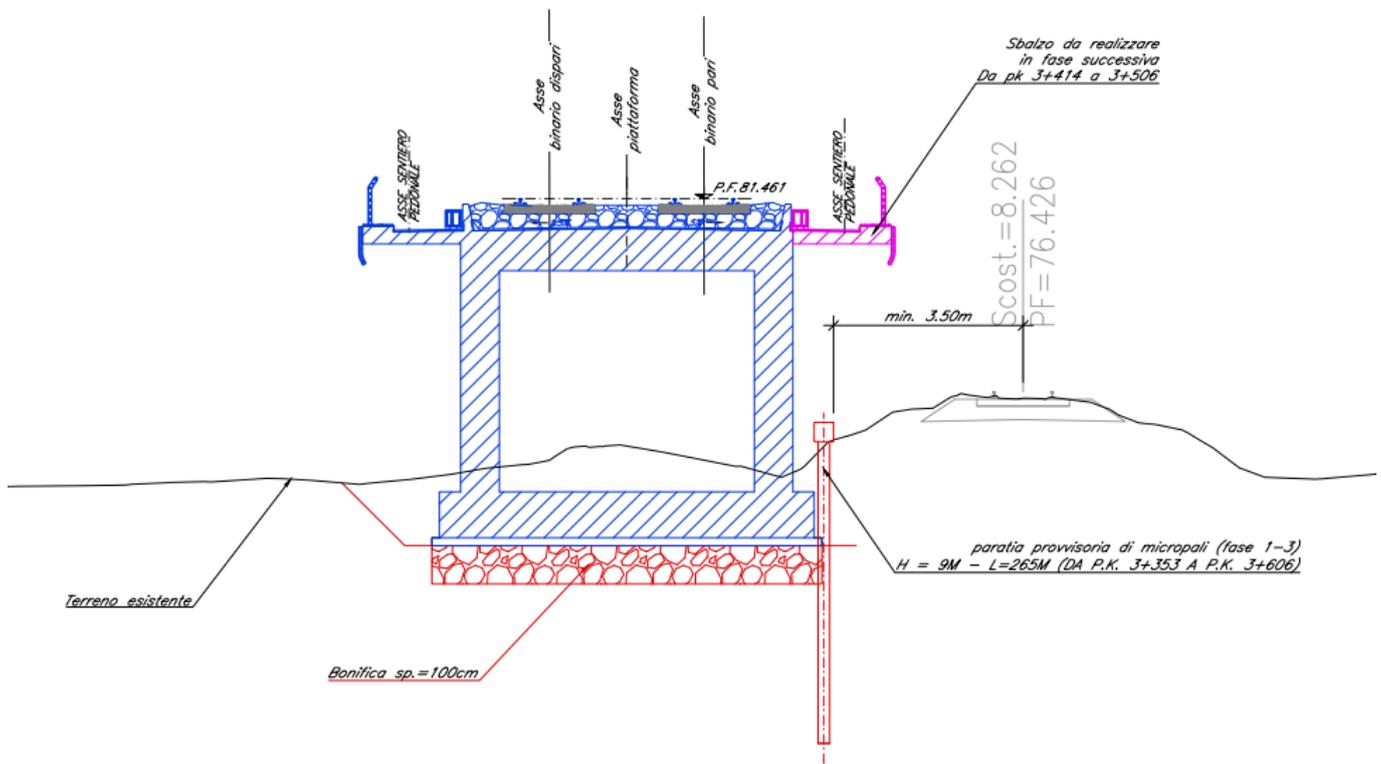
SL28 – Fase realizzativa 1, 2 e 3, sezione tipo scatolare. Tratti con scavo e sbalzo
